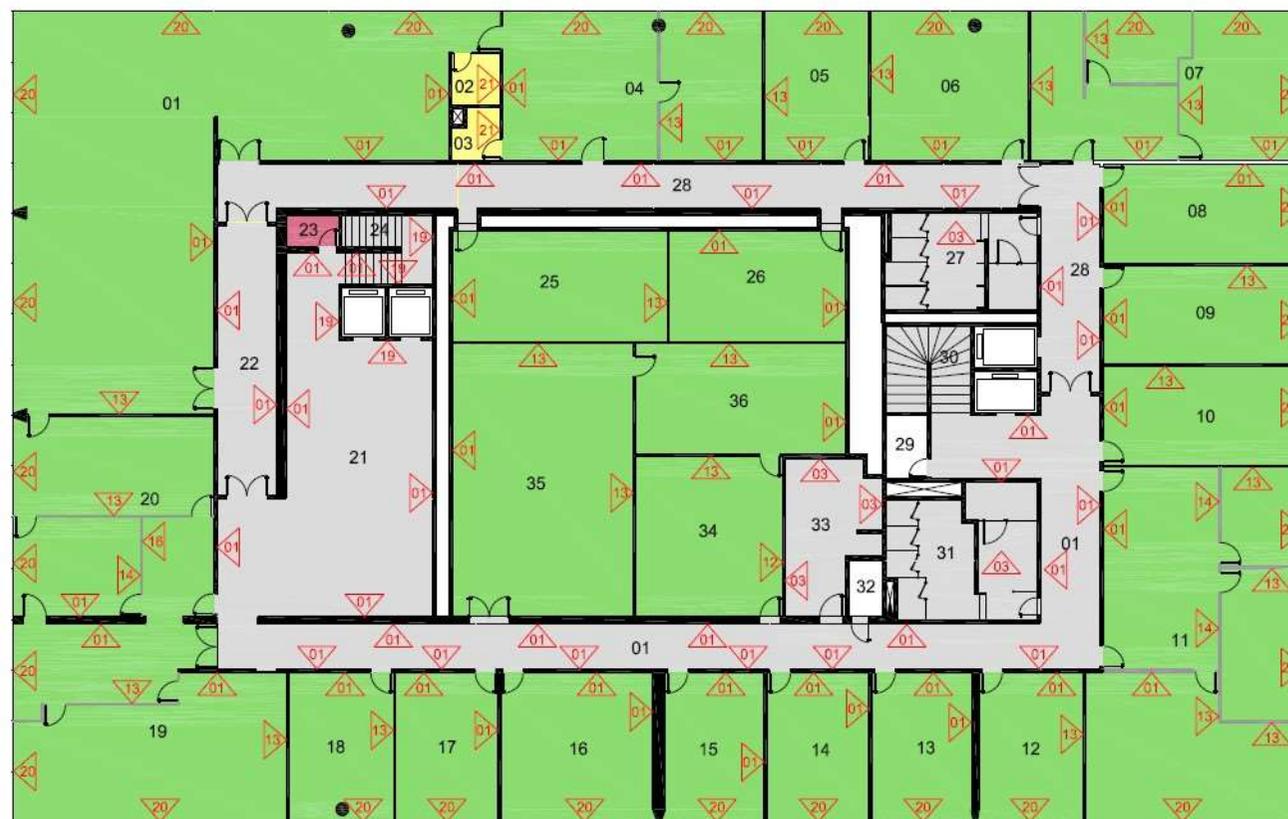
ADAPTAÇÃO DA PLANTA BAIXA DO TERCEIRO PAVIMENTO, PRANCHA 3/18. FONTE: INVENTÁRIO DO STF (IPHAN, 2013, P. 127).
